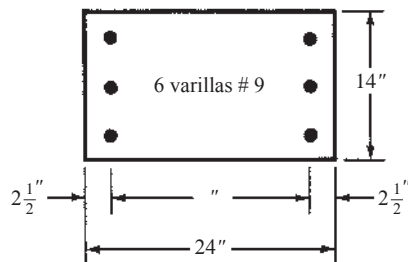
Sección transversal de la columna del Ejemplo 10.2.
